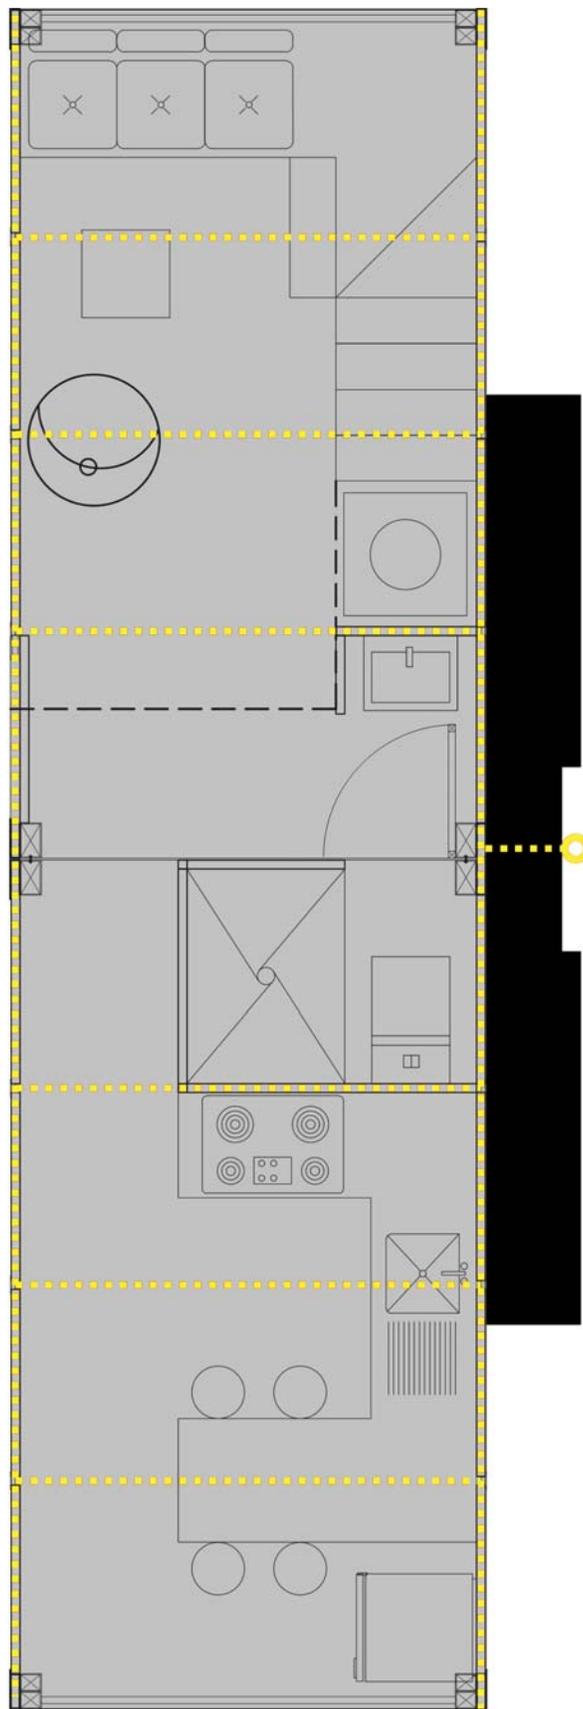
Diagrama en planta donde se muestran las conexiones eléctricas y su paso por los perfiles de la estructura del módulo.
